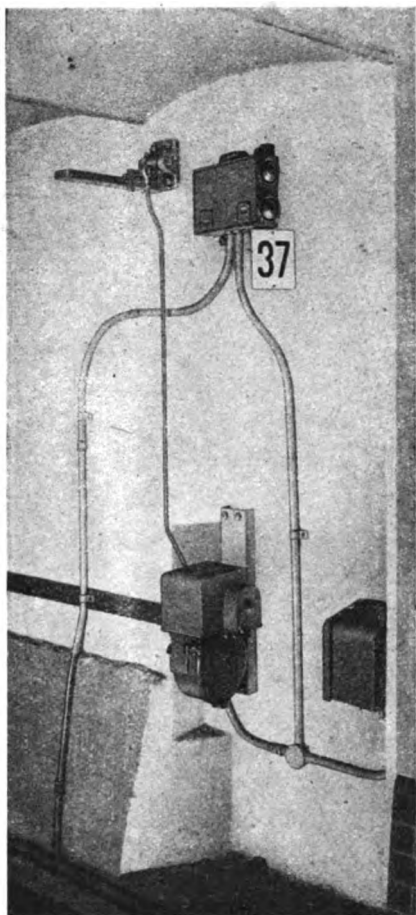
Lichtsignal, Fahrsperrung mit Westinghouse-Antrieb und Relais an einer Tunnelwand.
